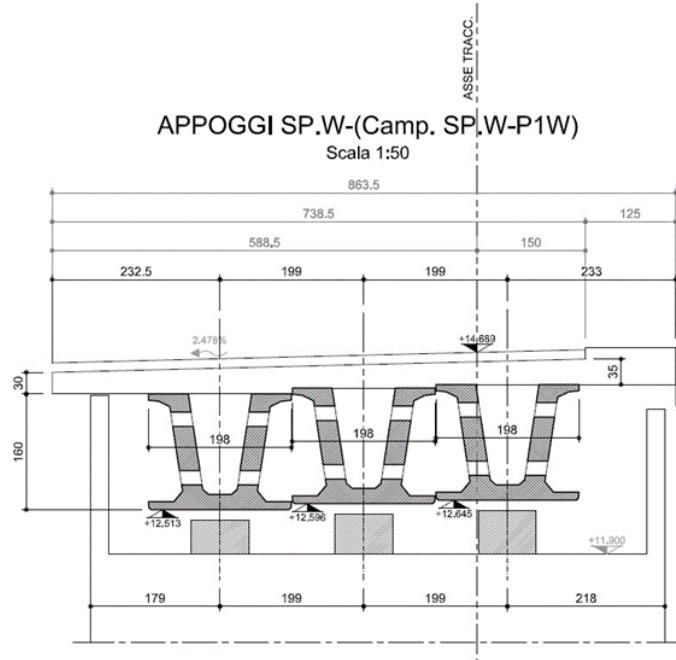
Sezione trasversale Campata 1 (a 3 travi) – Rampa W – SP_W
